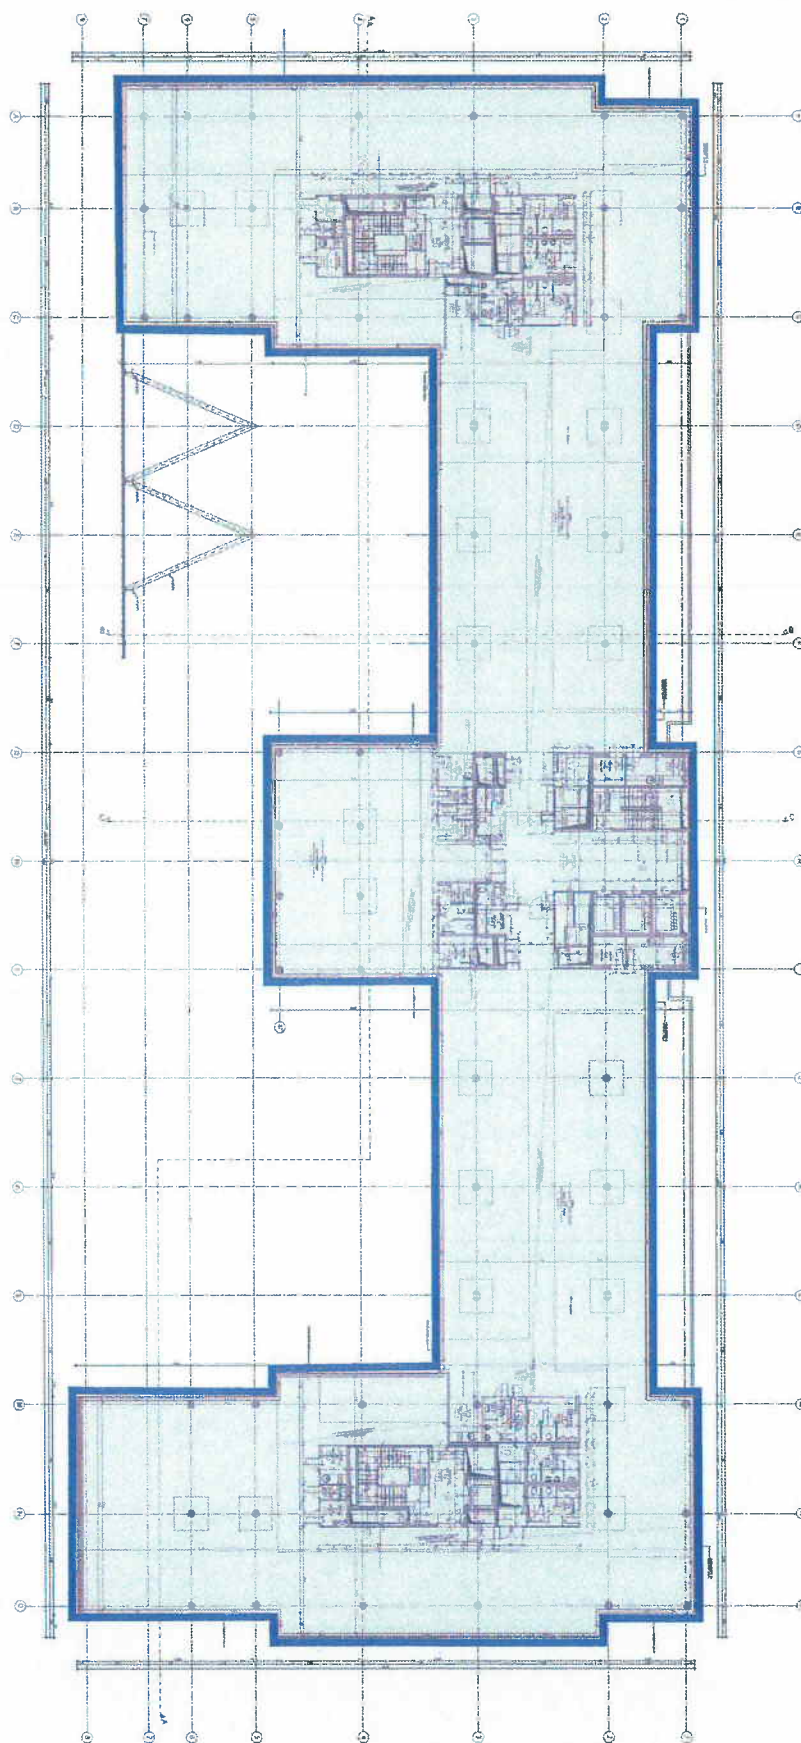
Grundriss des 3.-6. Obergeschosses mit Eintragung der thermischen Hülle (blaue Fläche bzw. blaue Linie).
